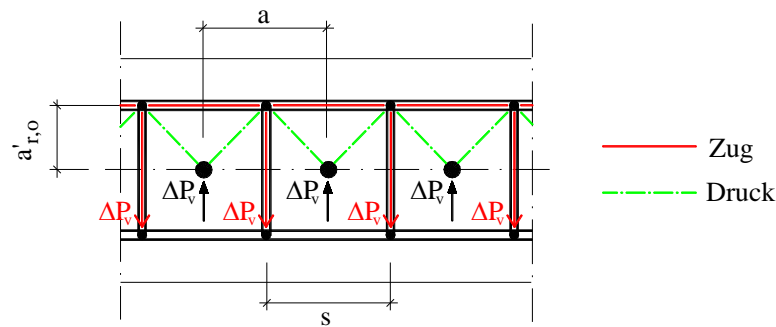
Stabwerkmodell für die Beanspruchung der Bügel- und Längsbewehrung
